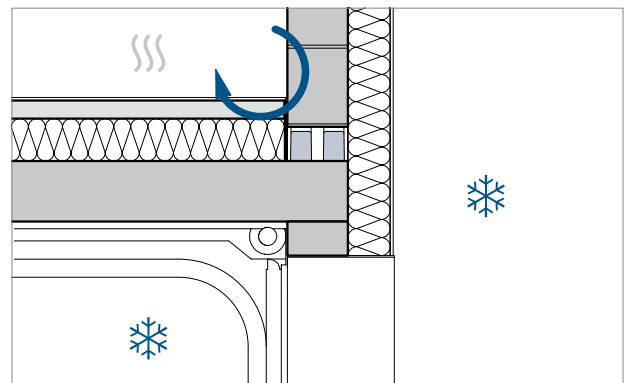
Pos ③: Wärmefluss bei Rolltorkonstruktion mit Schöck Scconnex® Typ M
